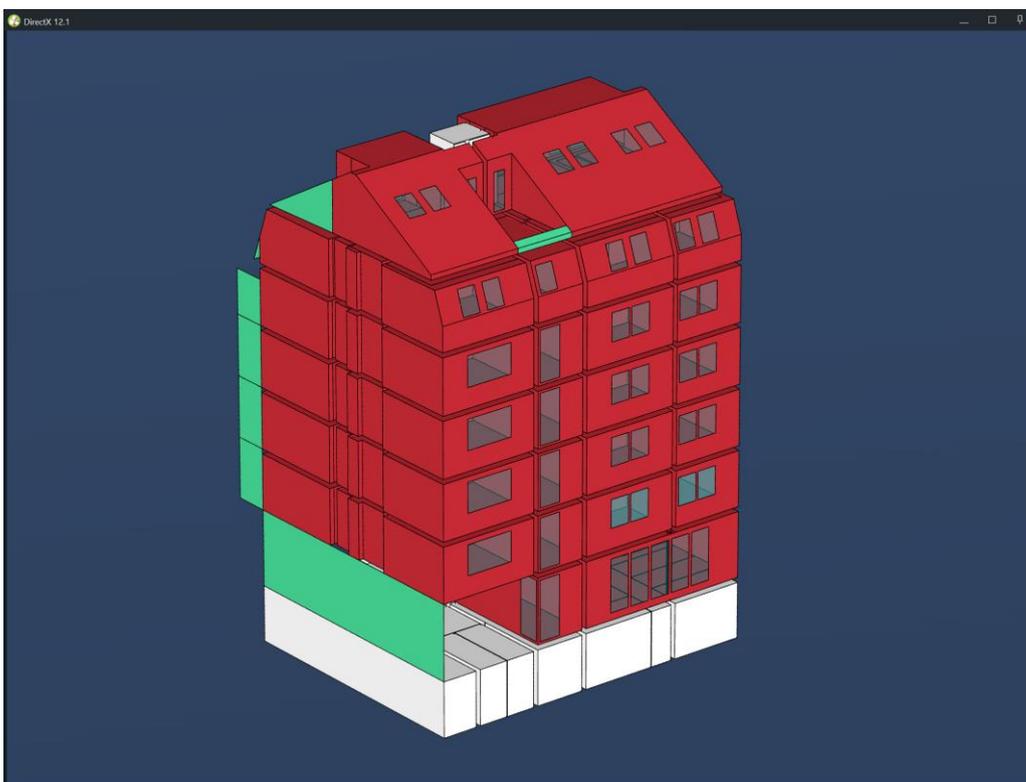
Detailliertes Gebäudemodell Straßenansicht thermische Zonen Variante 3
